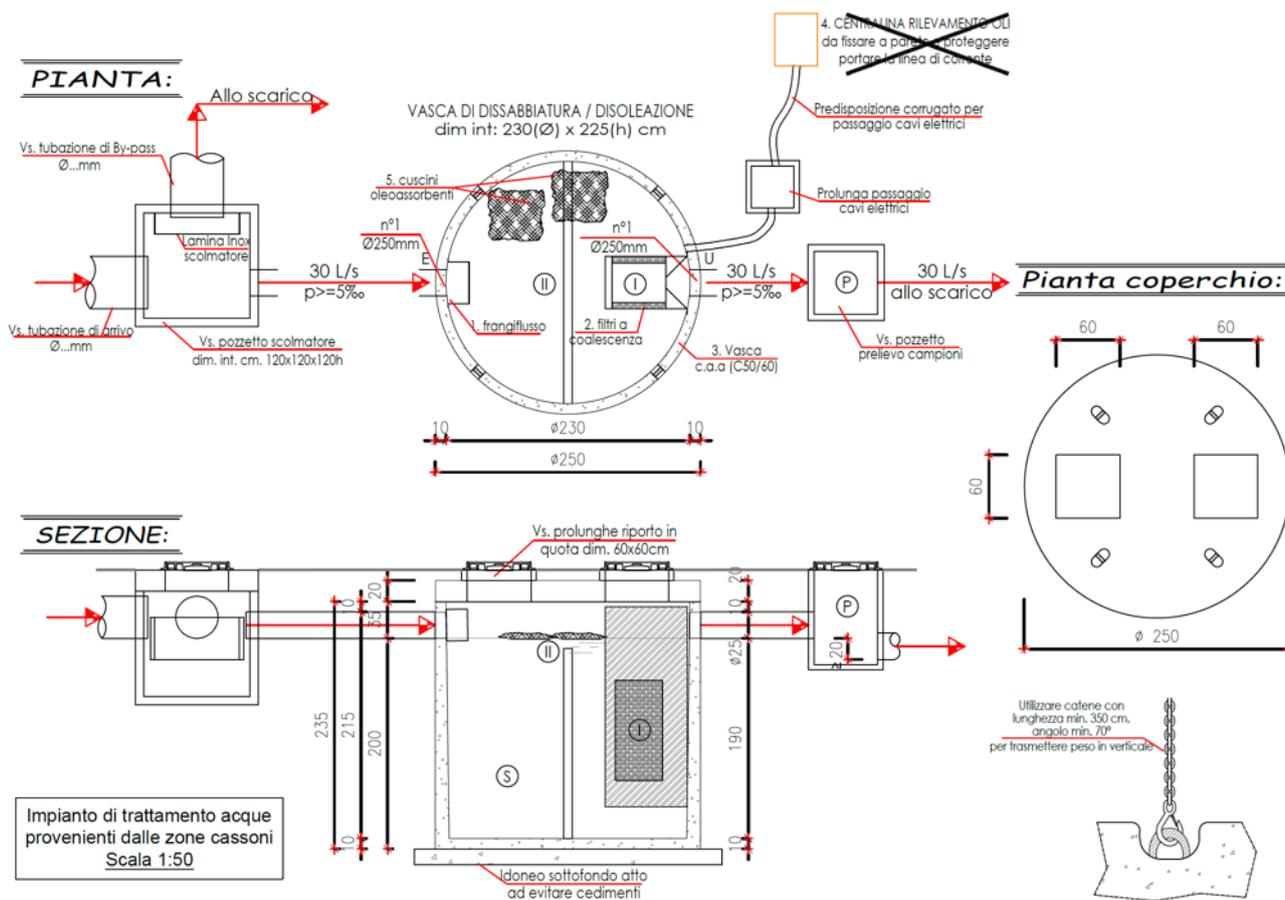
pianta dell'impianto di trattamento delle acque provenienti dalle aree di deposito rifiuti
